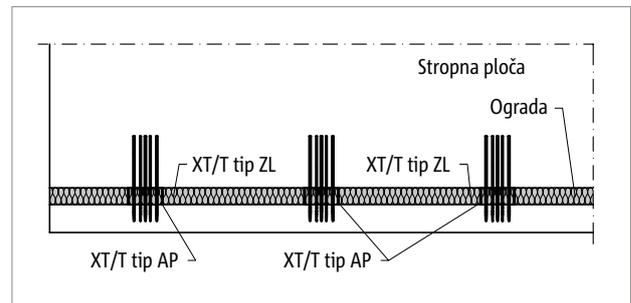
Schöck Isokorb® XT/T tip AP vertikalna ugradnja: Tlocrt, parapet na ploči
